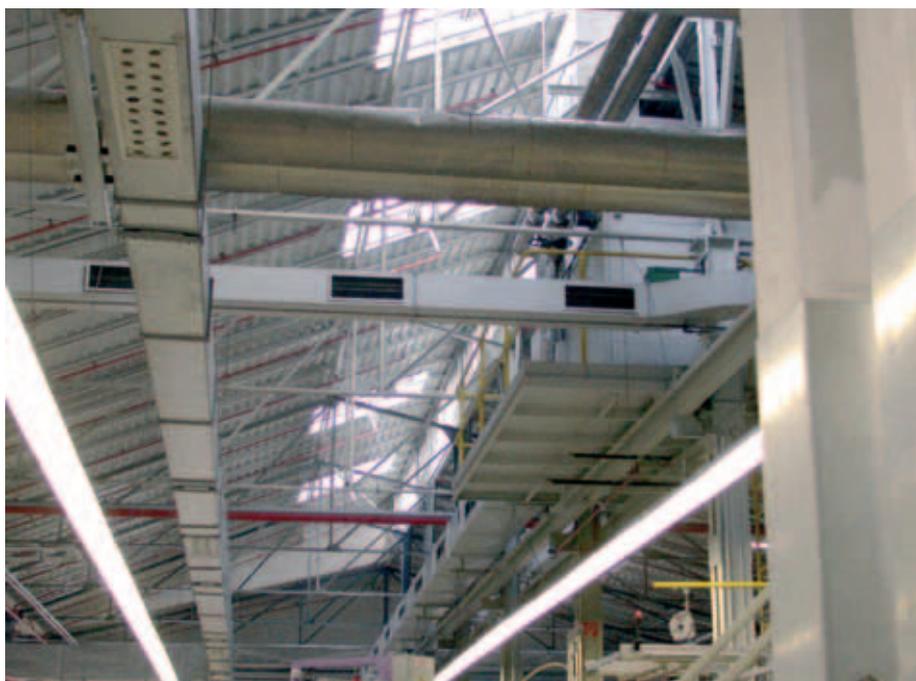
Individuelles Brandschutzkonzept für ein Industrieobjekt: Dachtragkonstruktion mit Dachbindern in Stahlleichtbau, in F-0-Bauweise belassen.
